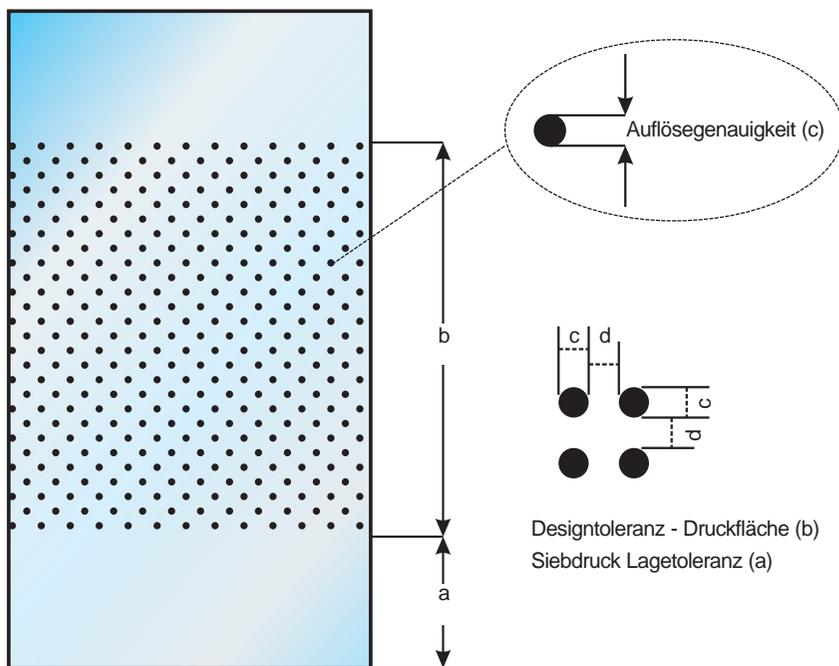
zu Tab. 21: Fehlerarten/Toleranzen für siebgedruckte Gläser
